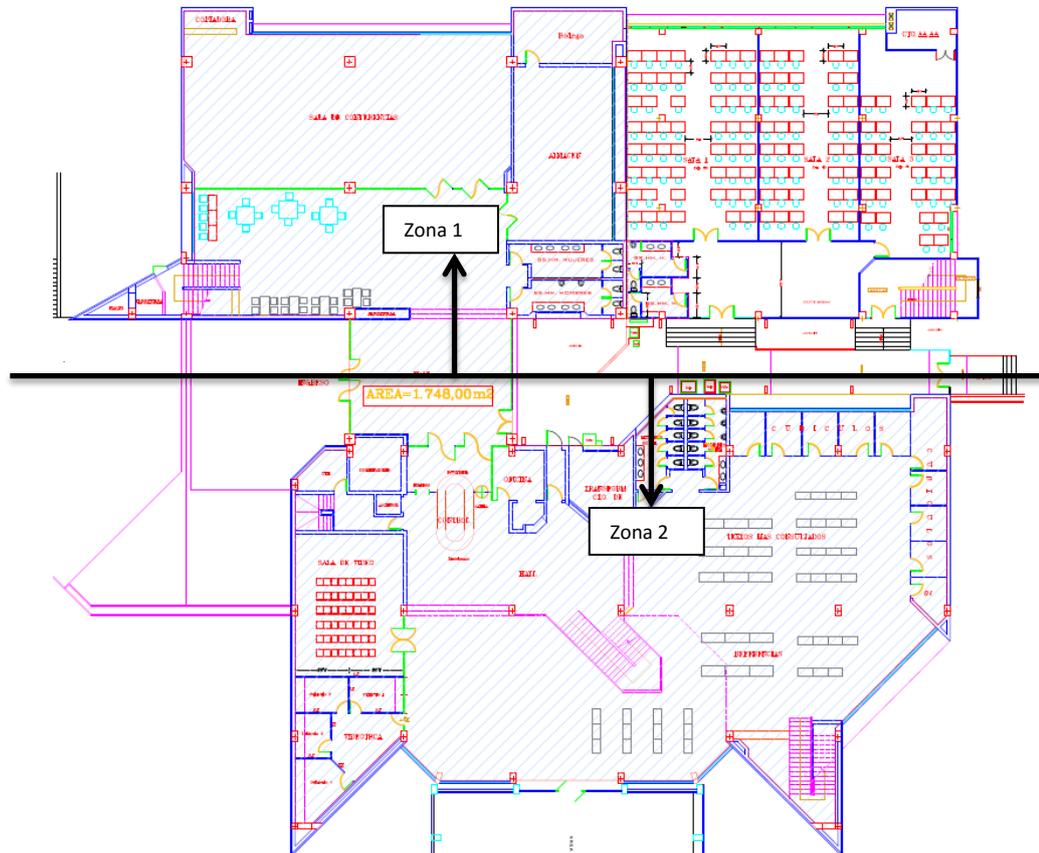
Planos, Planta Baja, Zona 1 y 2
